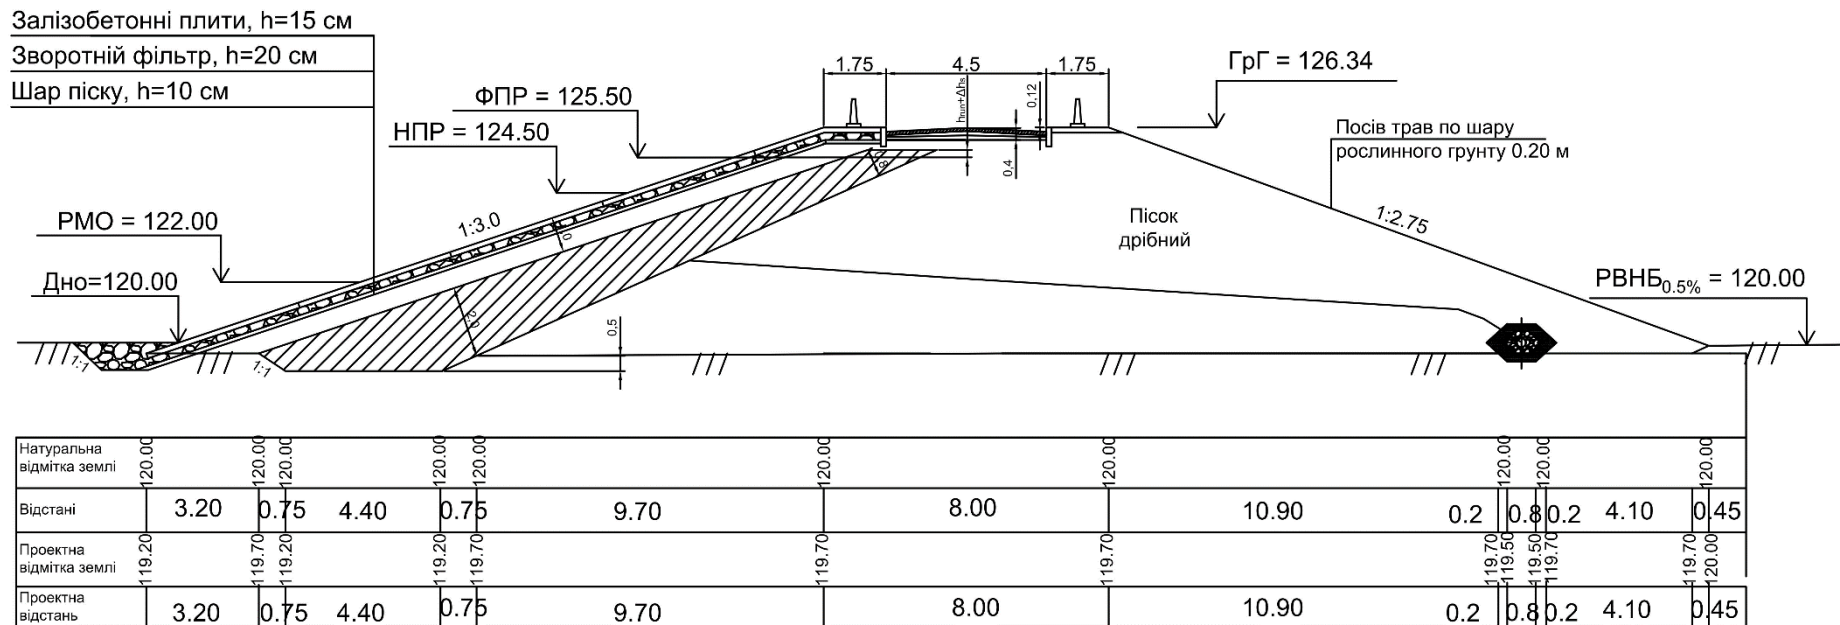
Ґрунтова гребля з екраном та трубчатим дренажем
